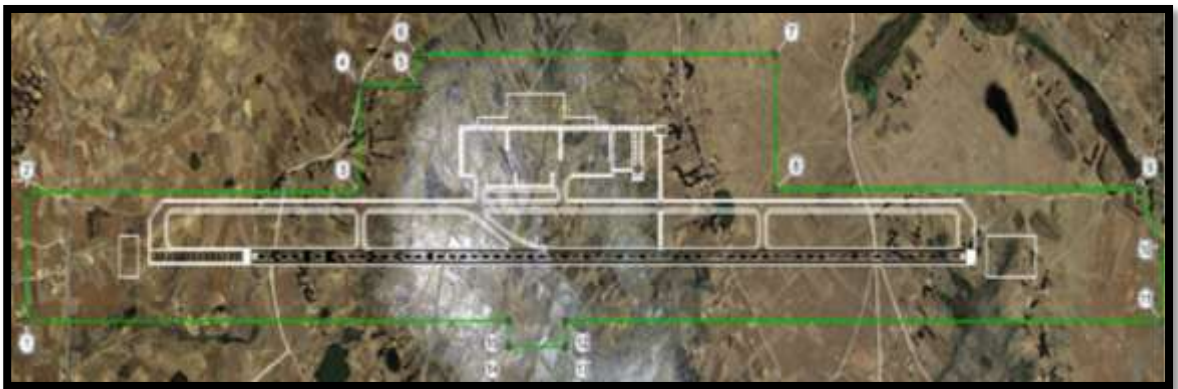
Plano del Área perimetral del Nuevo Aeropuerto
